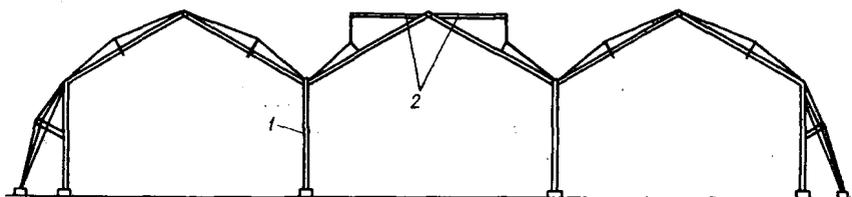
Поперечный разрез пленочной рассадной теплицы из деревометаллических конструкций:
